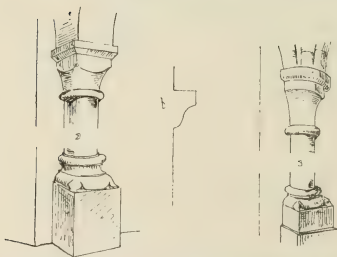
Lipp. Grundriss und Details der katholischen Pfarrkirche.
